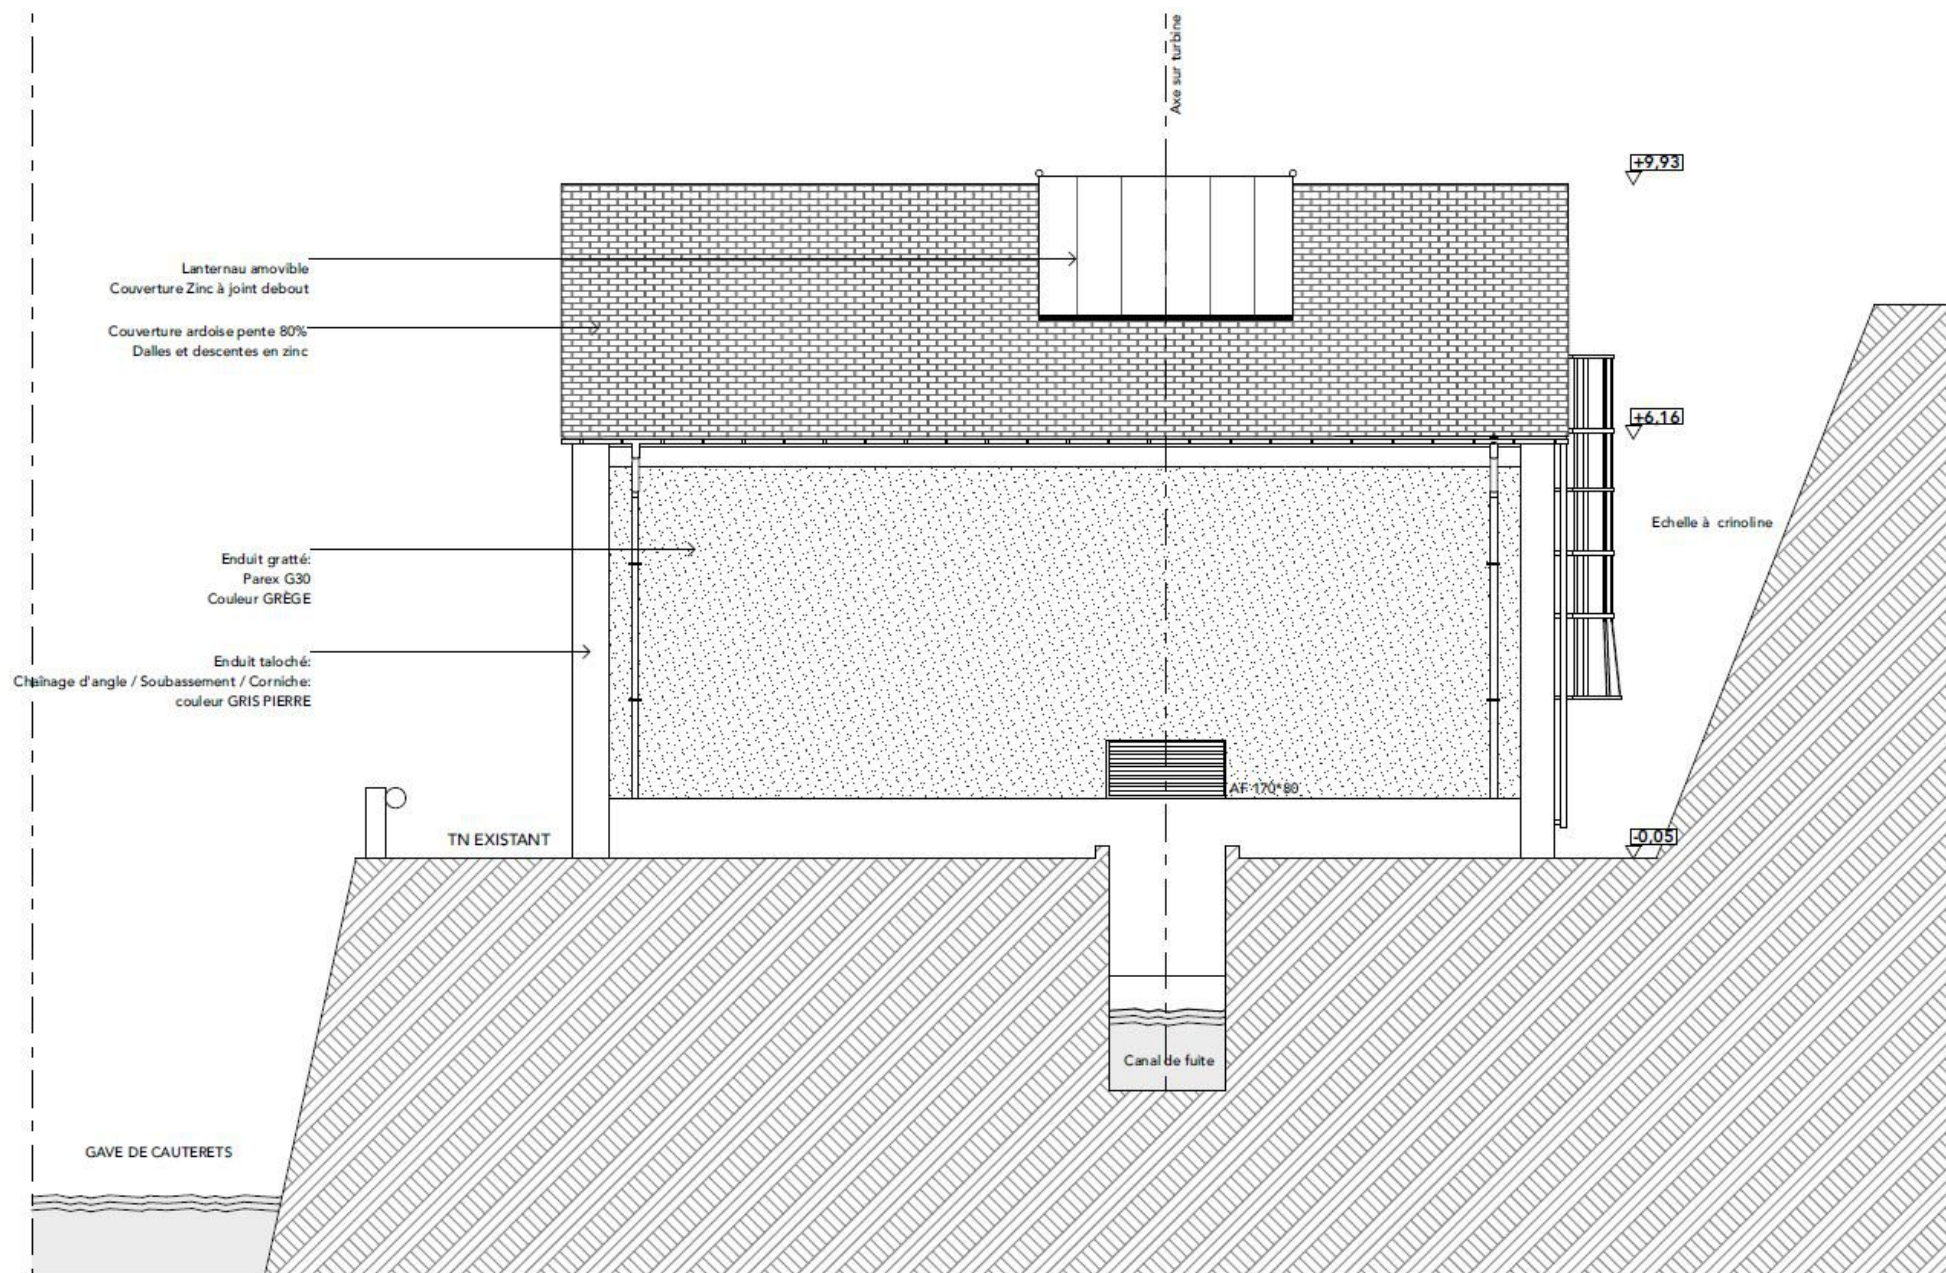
Façade sud bâtiment centrale (source : PYREN et BB Architectes Associés)
